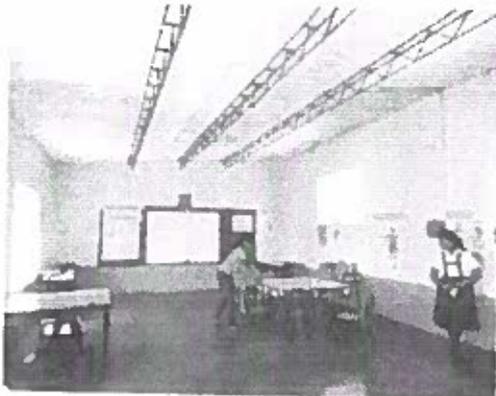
y 03: Vista interior de aula nivel primaria y columna de concreto ejecutada sin criterio técnico con acero expuesto
